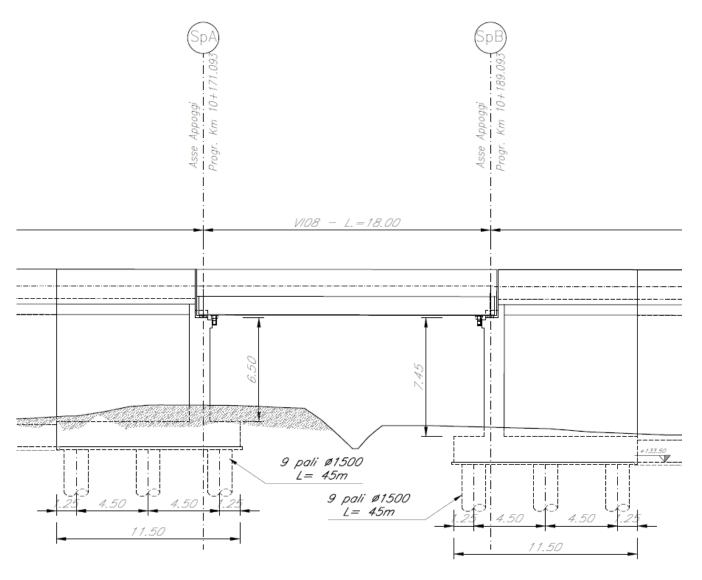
Prospetto longintufinale dell'impalcato Doppio Binario a travi incorporate
